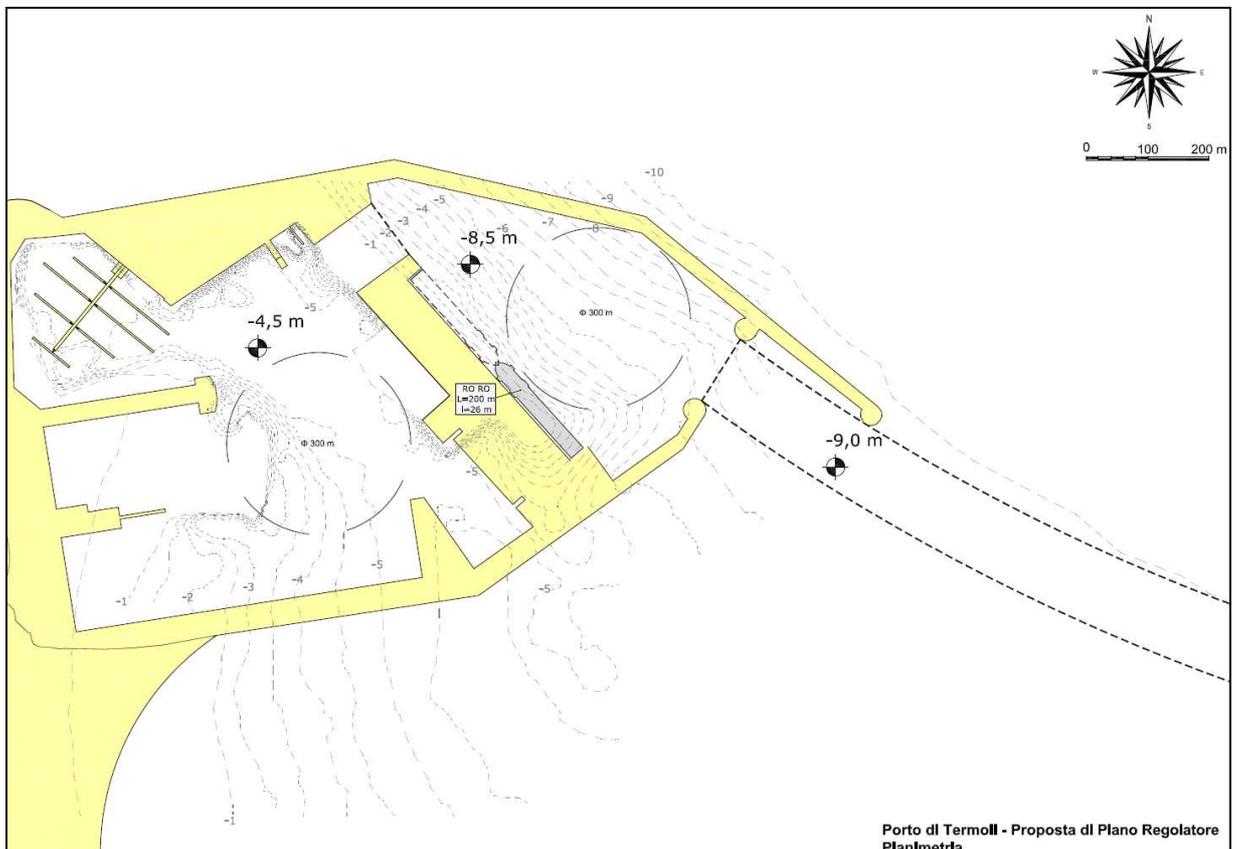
A Tavola "Lay out prp termoli V02.dwg" – planimetria della proposta di PRP [2]
